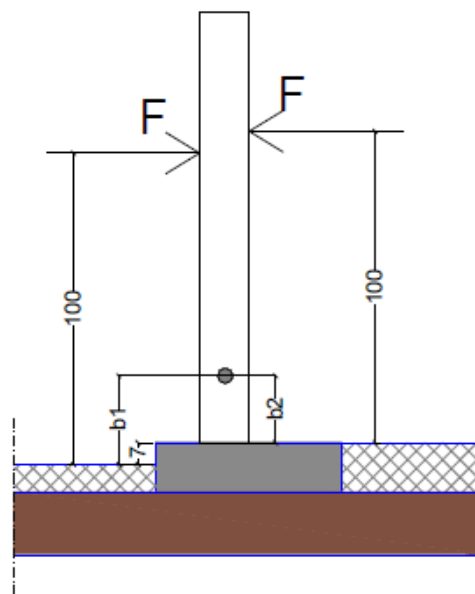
Bracci delle azioni di progetto in funzione della pavimentazione
